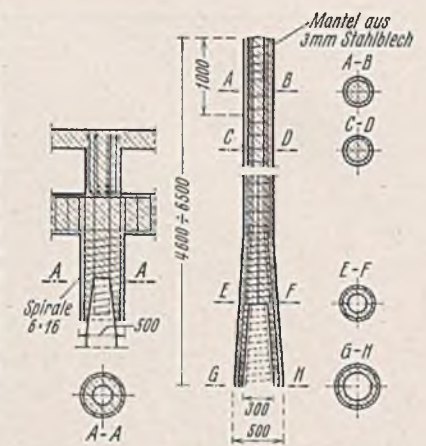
Verbindungen zwischen den Pfählen und den Eisenbetonköpfen bzw. den Trägern der Kaidecke.
